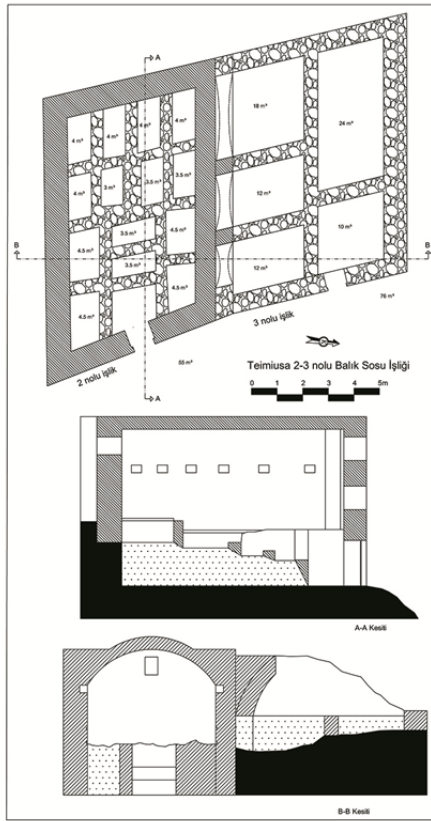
Teimiussa 2-3 Nolu İşlik Planı
